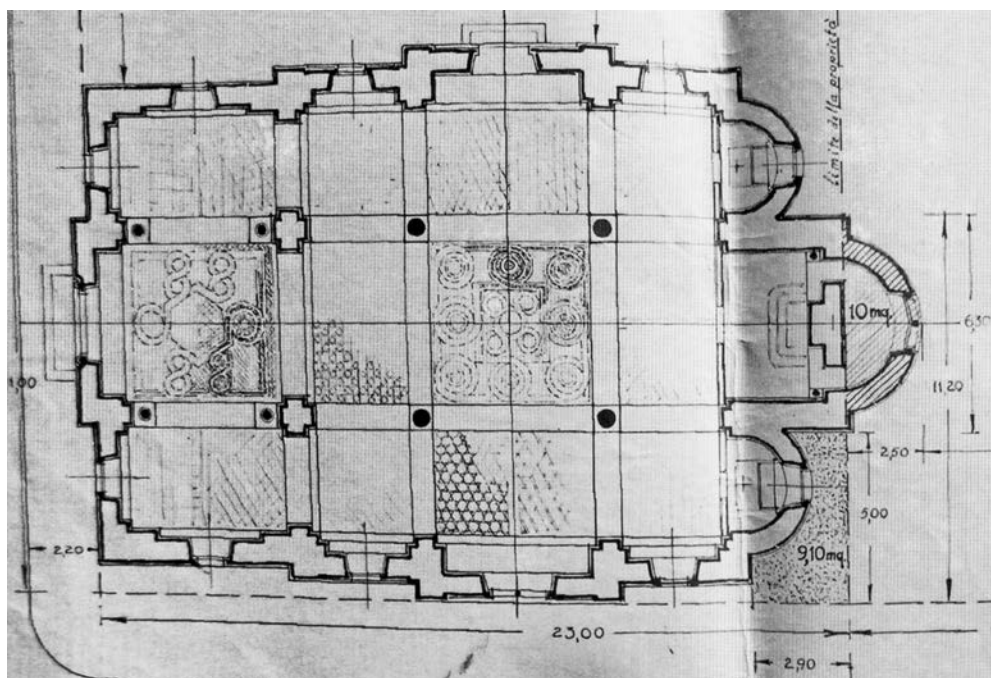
Progetto di sistemazione del pavimento dell'ing. Lojacono.
